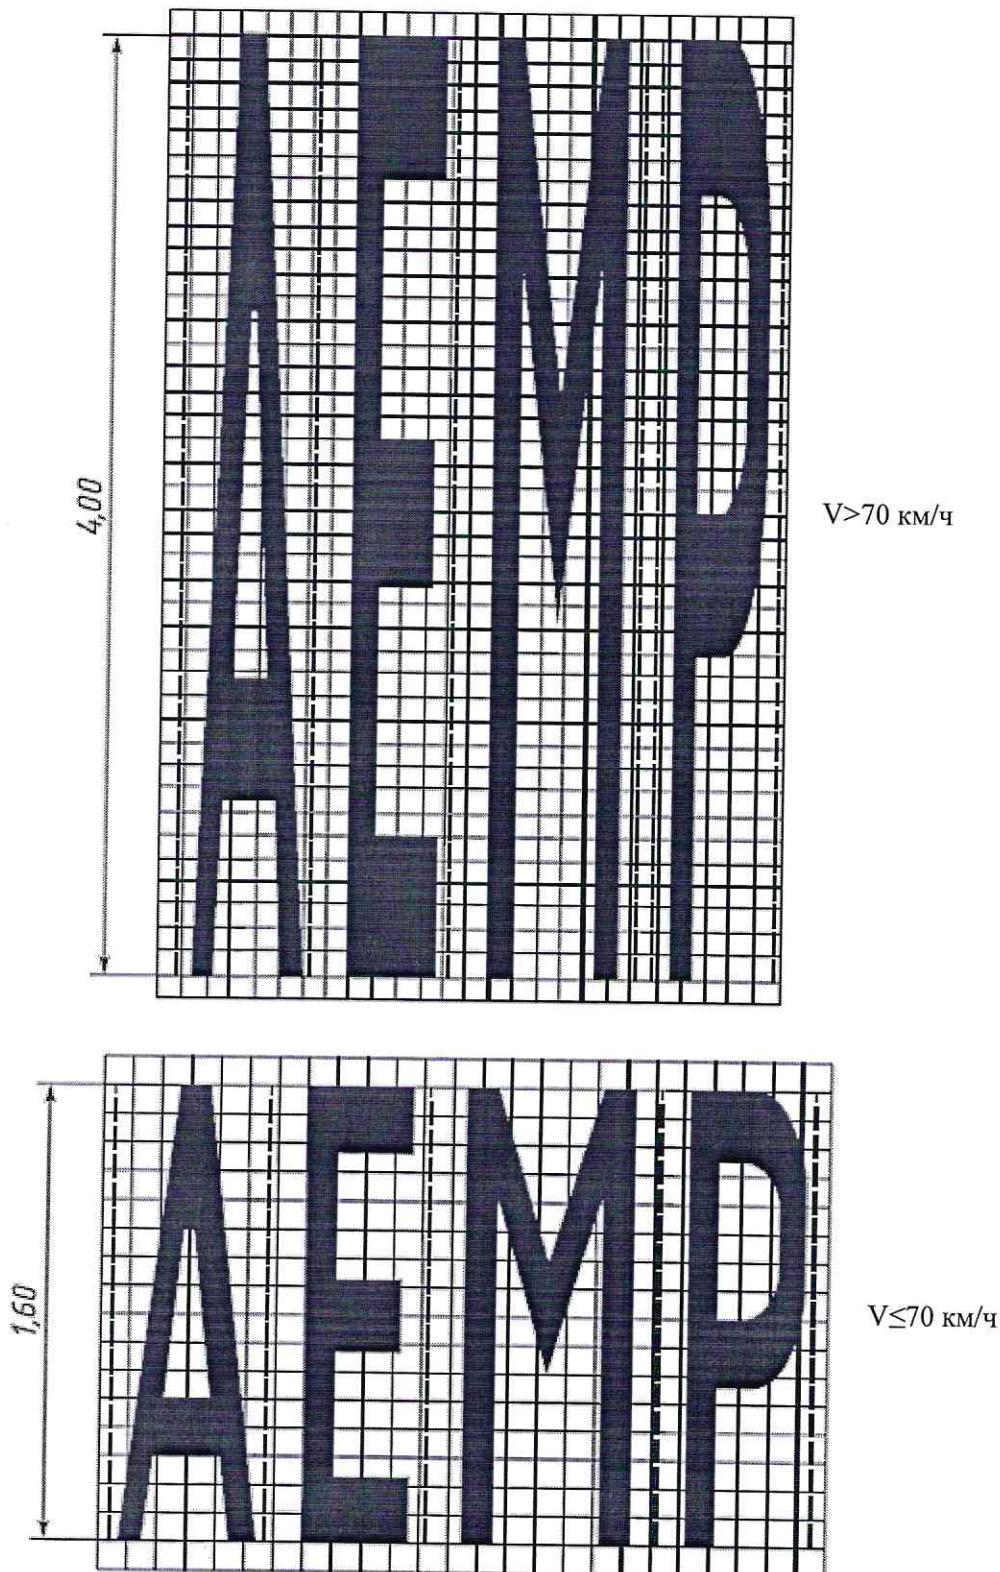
Форма, расположение и размеры букв разметки типа 1.22
